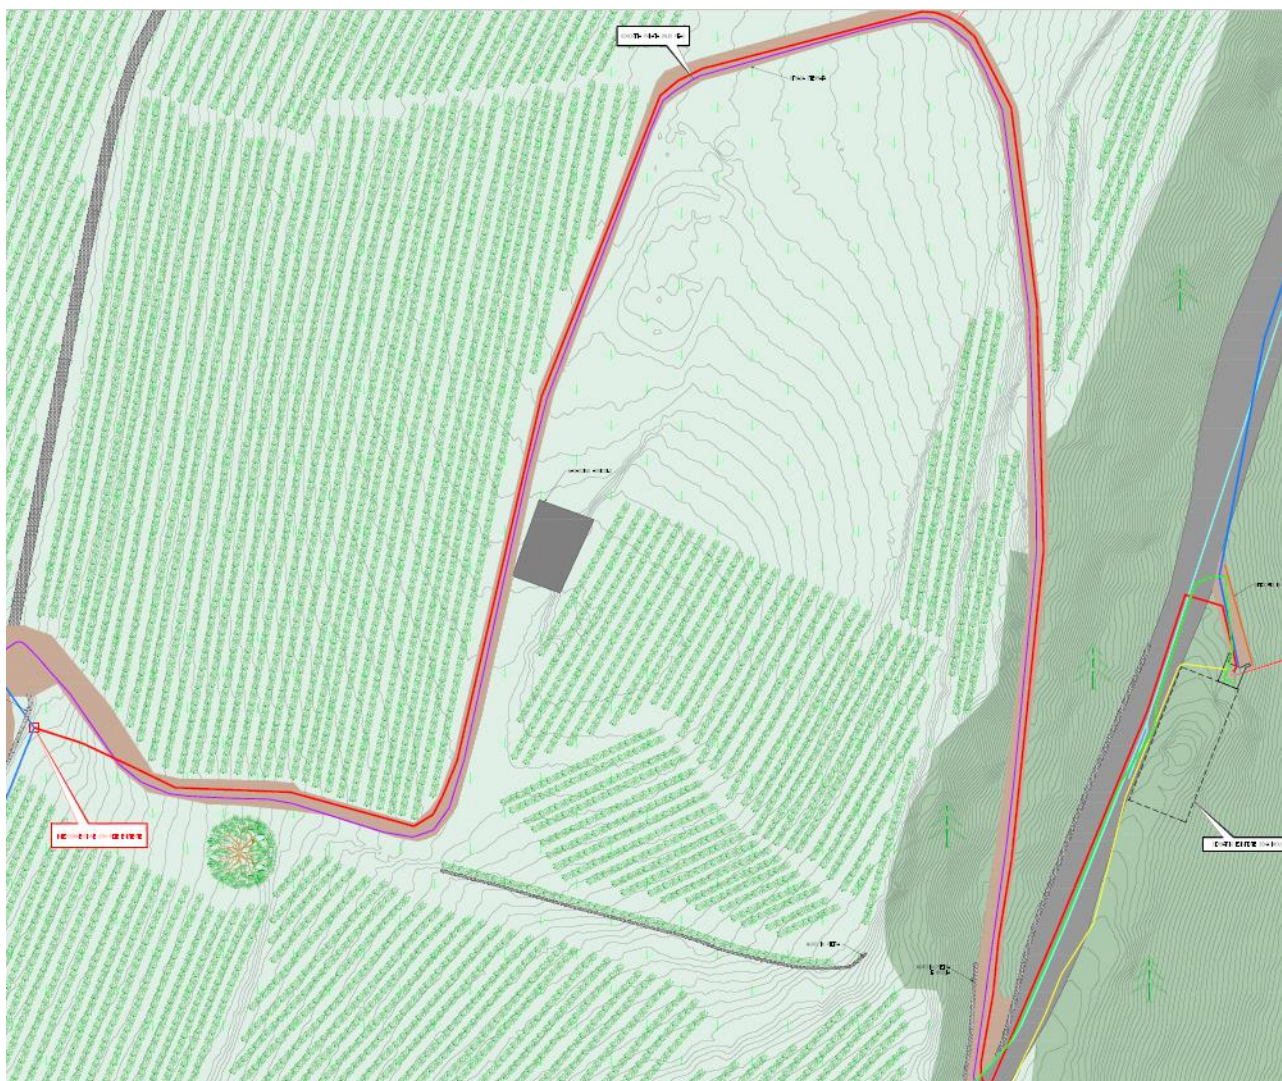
Estratto planimetria sottoservizi sorgente S1A
